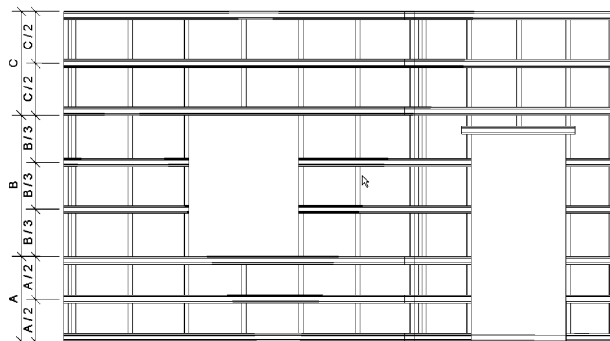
Монтажная схема горизонтальной обрешетки для стен типа 1
